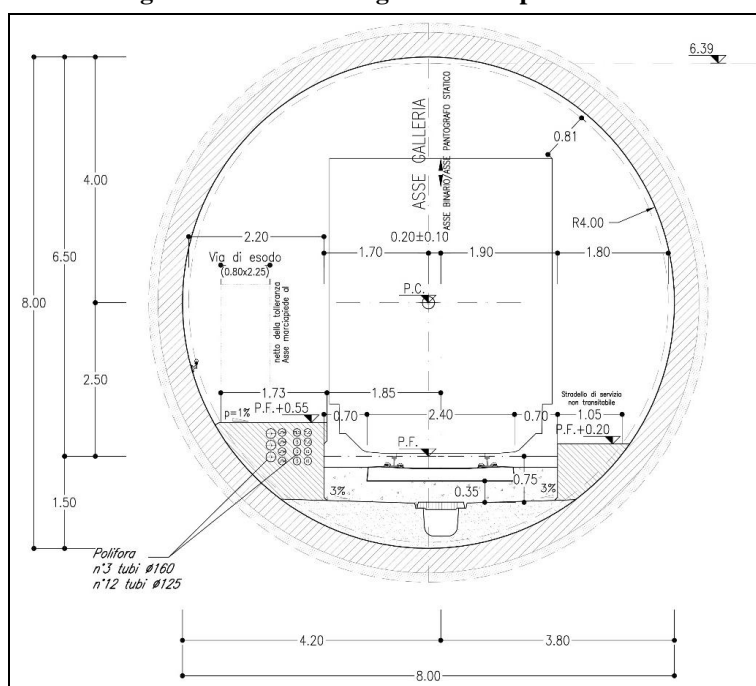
Sezione di intradosso galleria di linea a singolo binario in scavo meccanizzato (sezione corrente)
